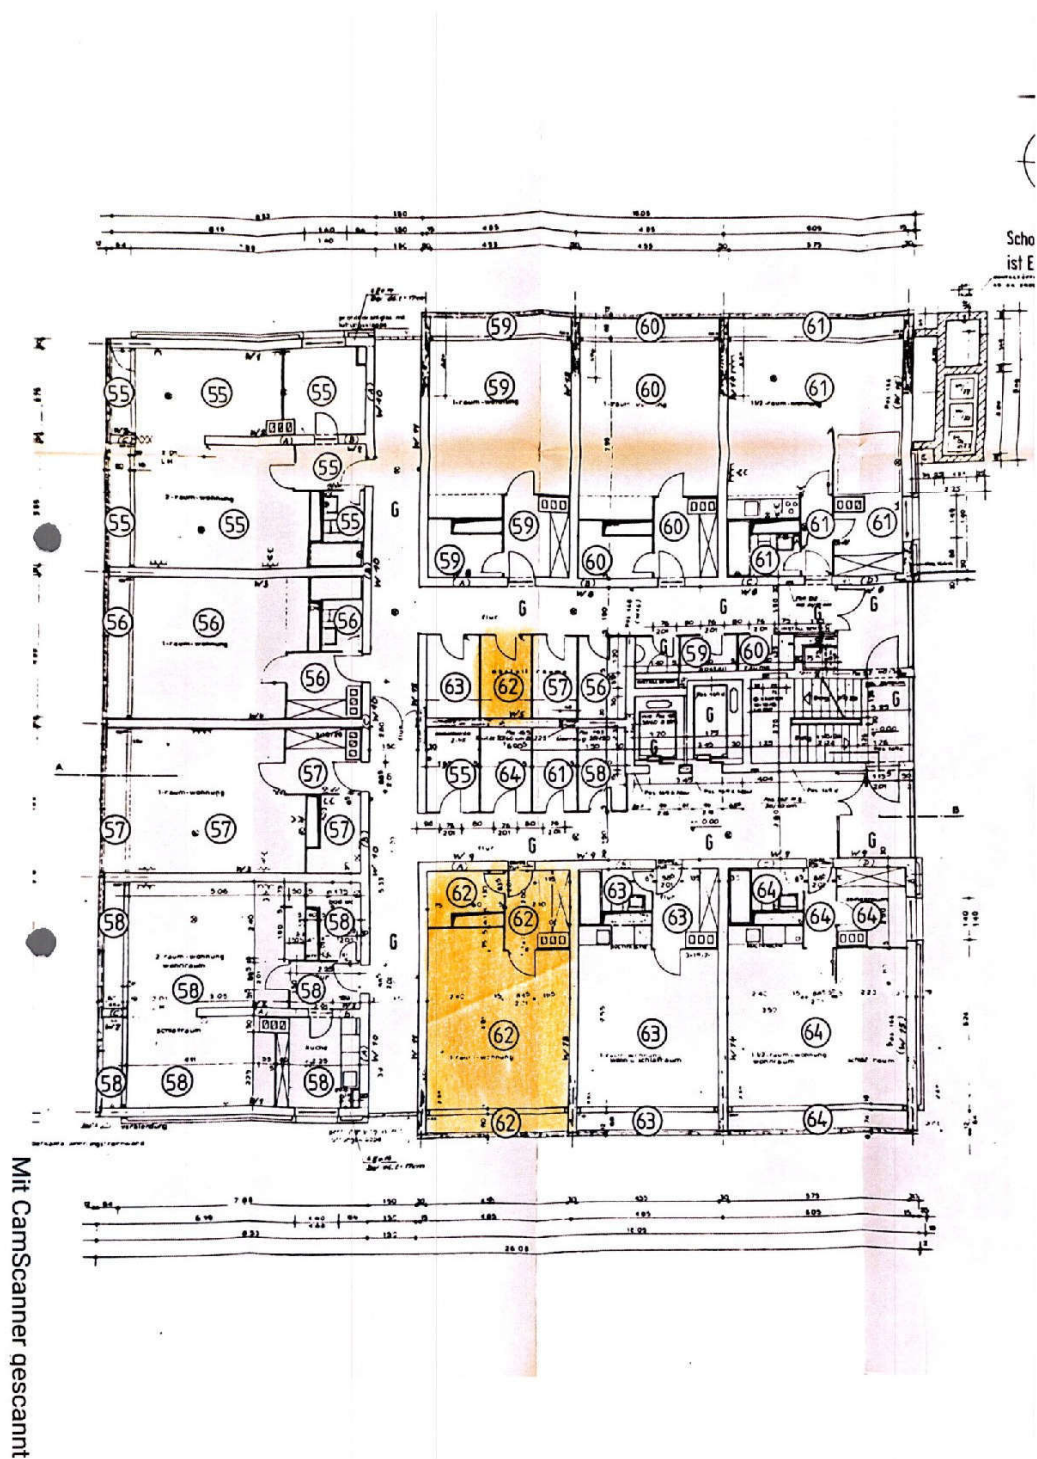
Gesamtplan 5.OG mit Kennzeichnung Bewertungsobjekt mit Abstellraum
